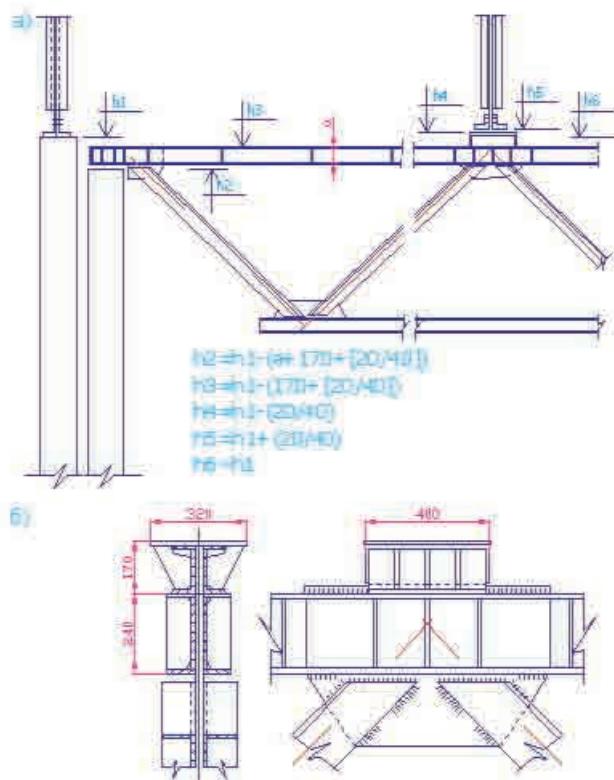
Проектно-технологические отметки конструкций при установке подстропильной фермы (а) и узел расположения опорного столика стропильной фермы (б)..
